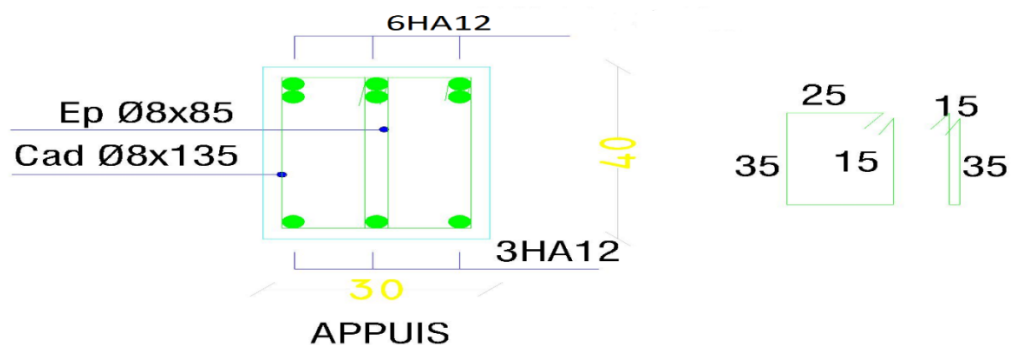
Ferraillage de la poutre principale au niveau terrasse, sur appui
